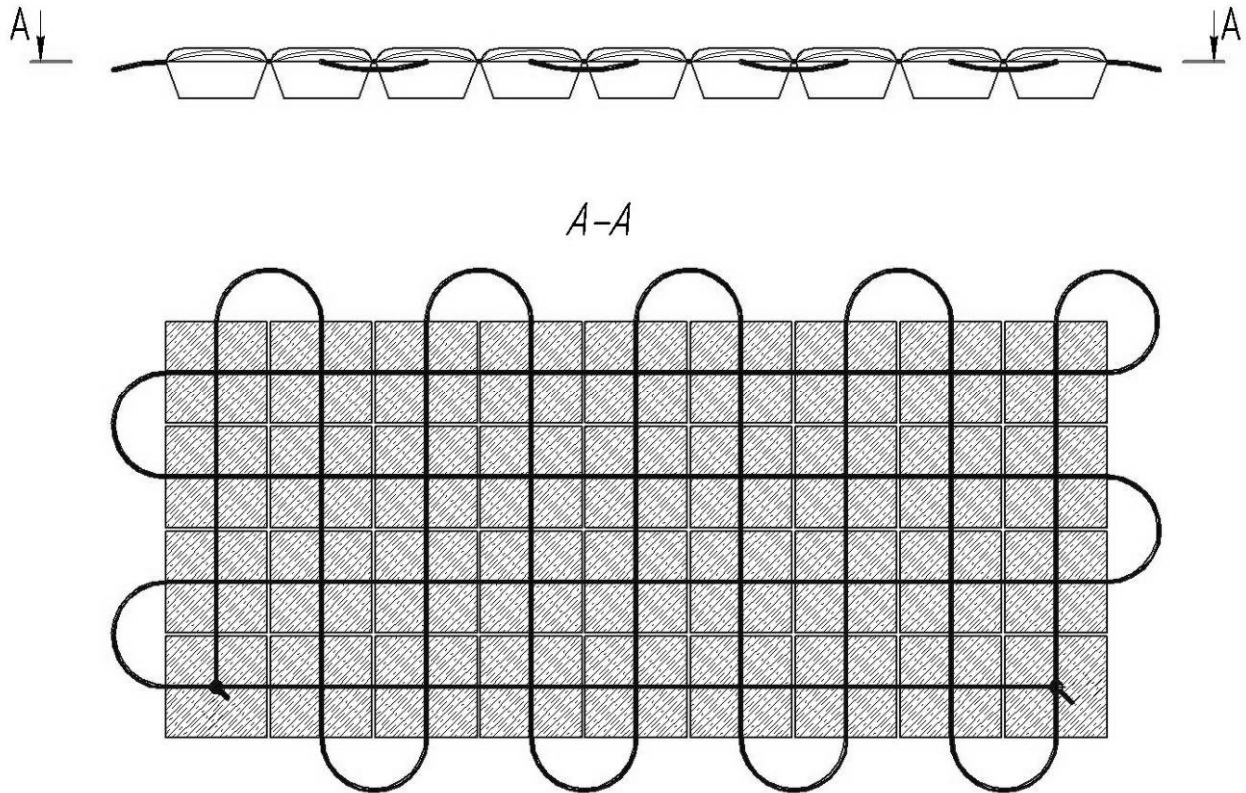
Схема укладки соединительного арматурного каната
